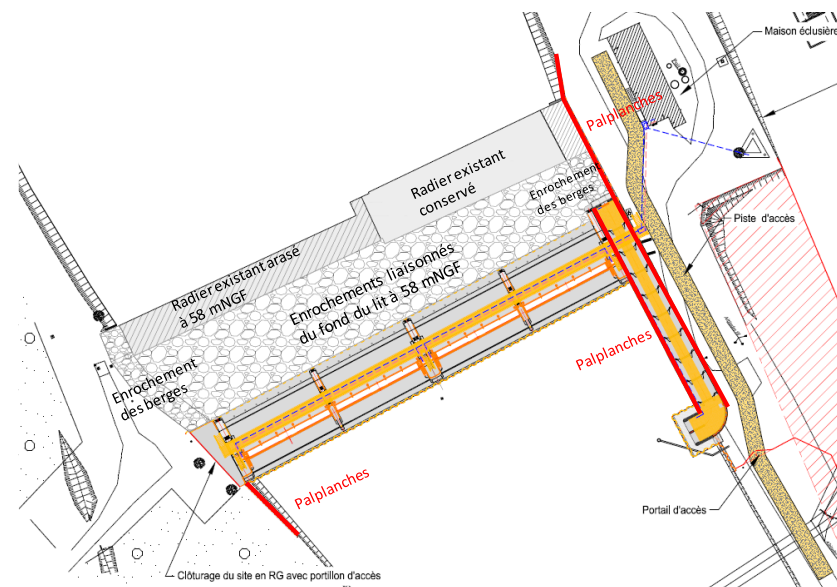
Bilan des modifications des berges et du fond du lit – vue en plan
